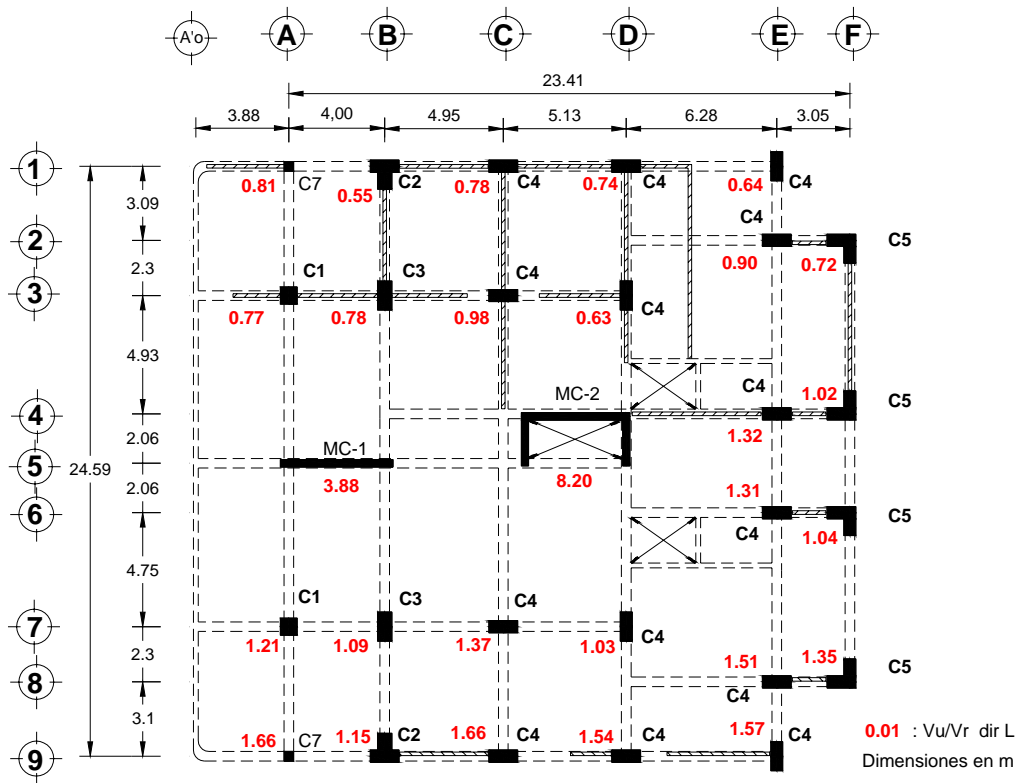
Relaciones entre el cortante último y el cortante resistente (V_u/V_r) en las columnas y muros de concreto de planta baja, para un análisis con $Q=2$
